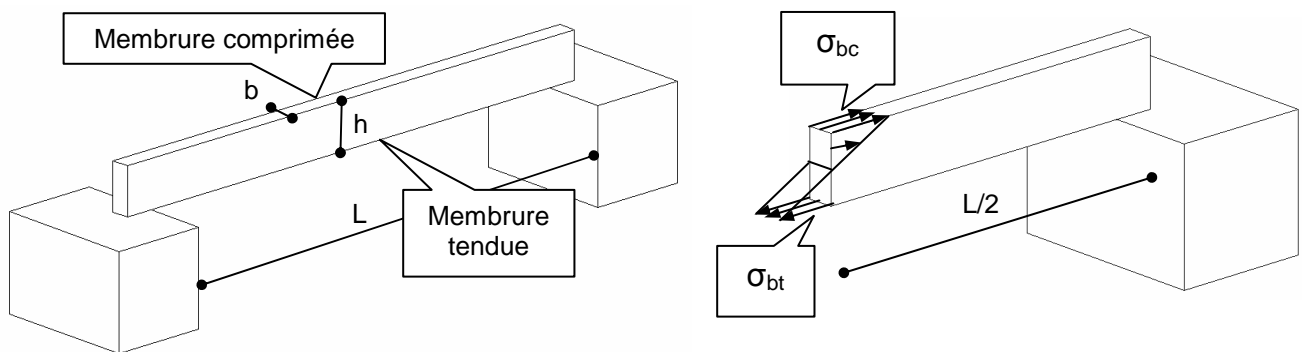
Poutre en béton non armé, de section droite rectangulaire $b \times h$, franchissant une portée de L mètres de nu à nu des appuis.
